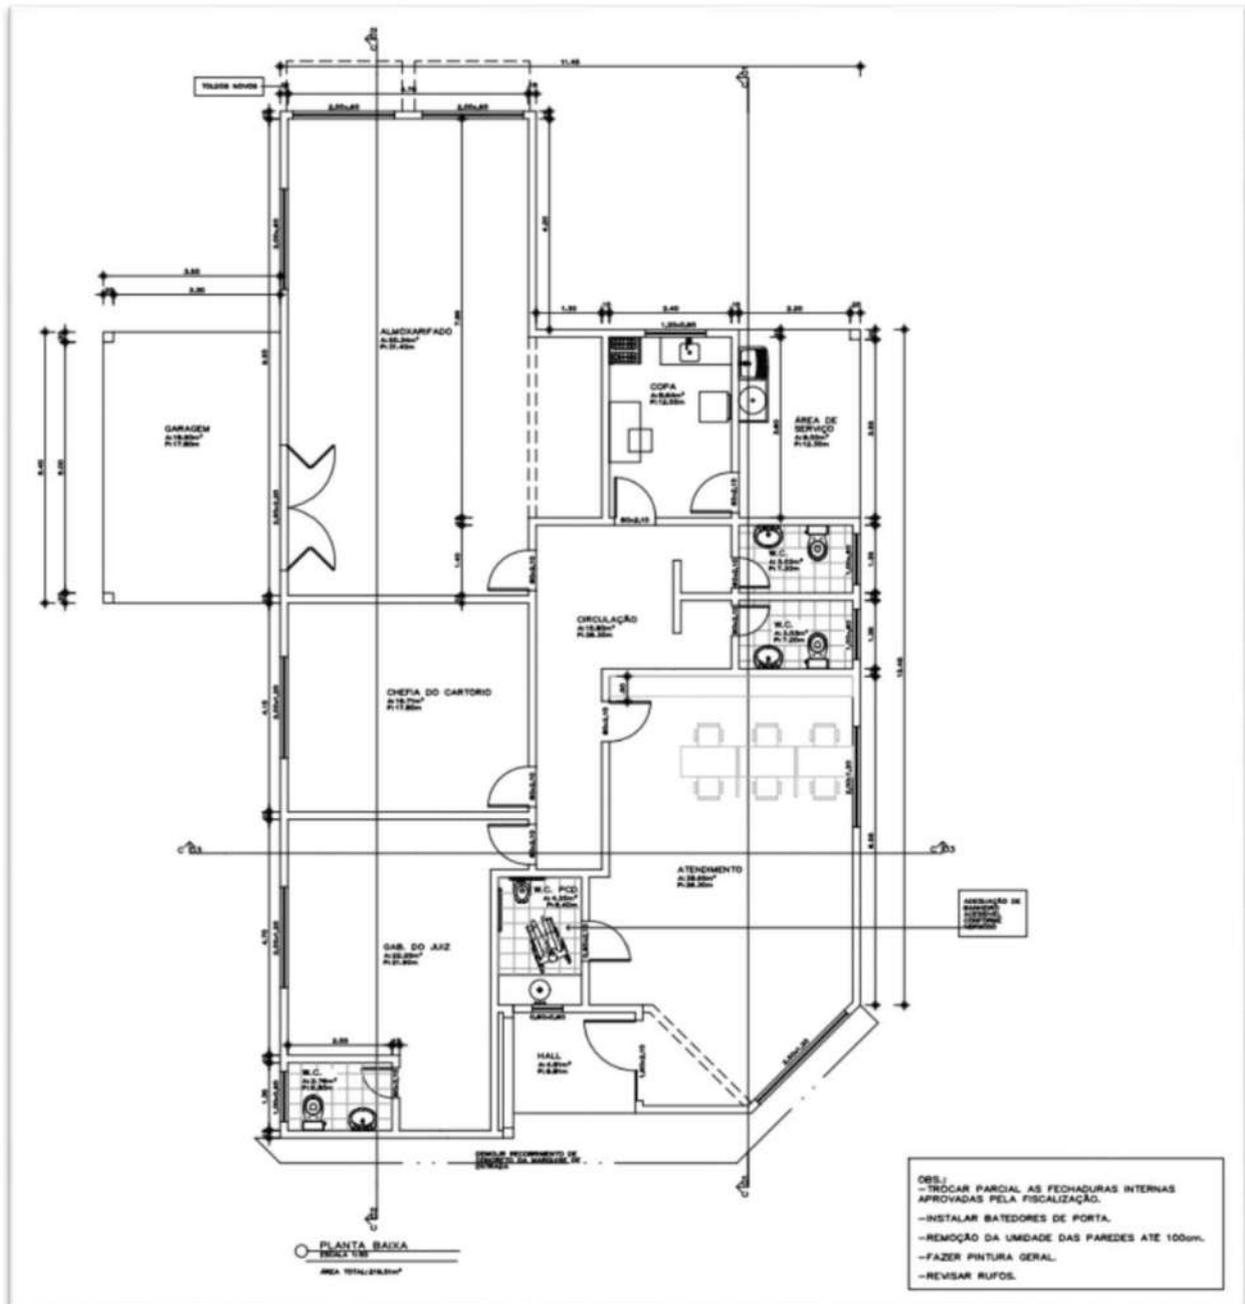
Planta Baixa Fórum (Modelo Padrão 01)
